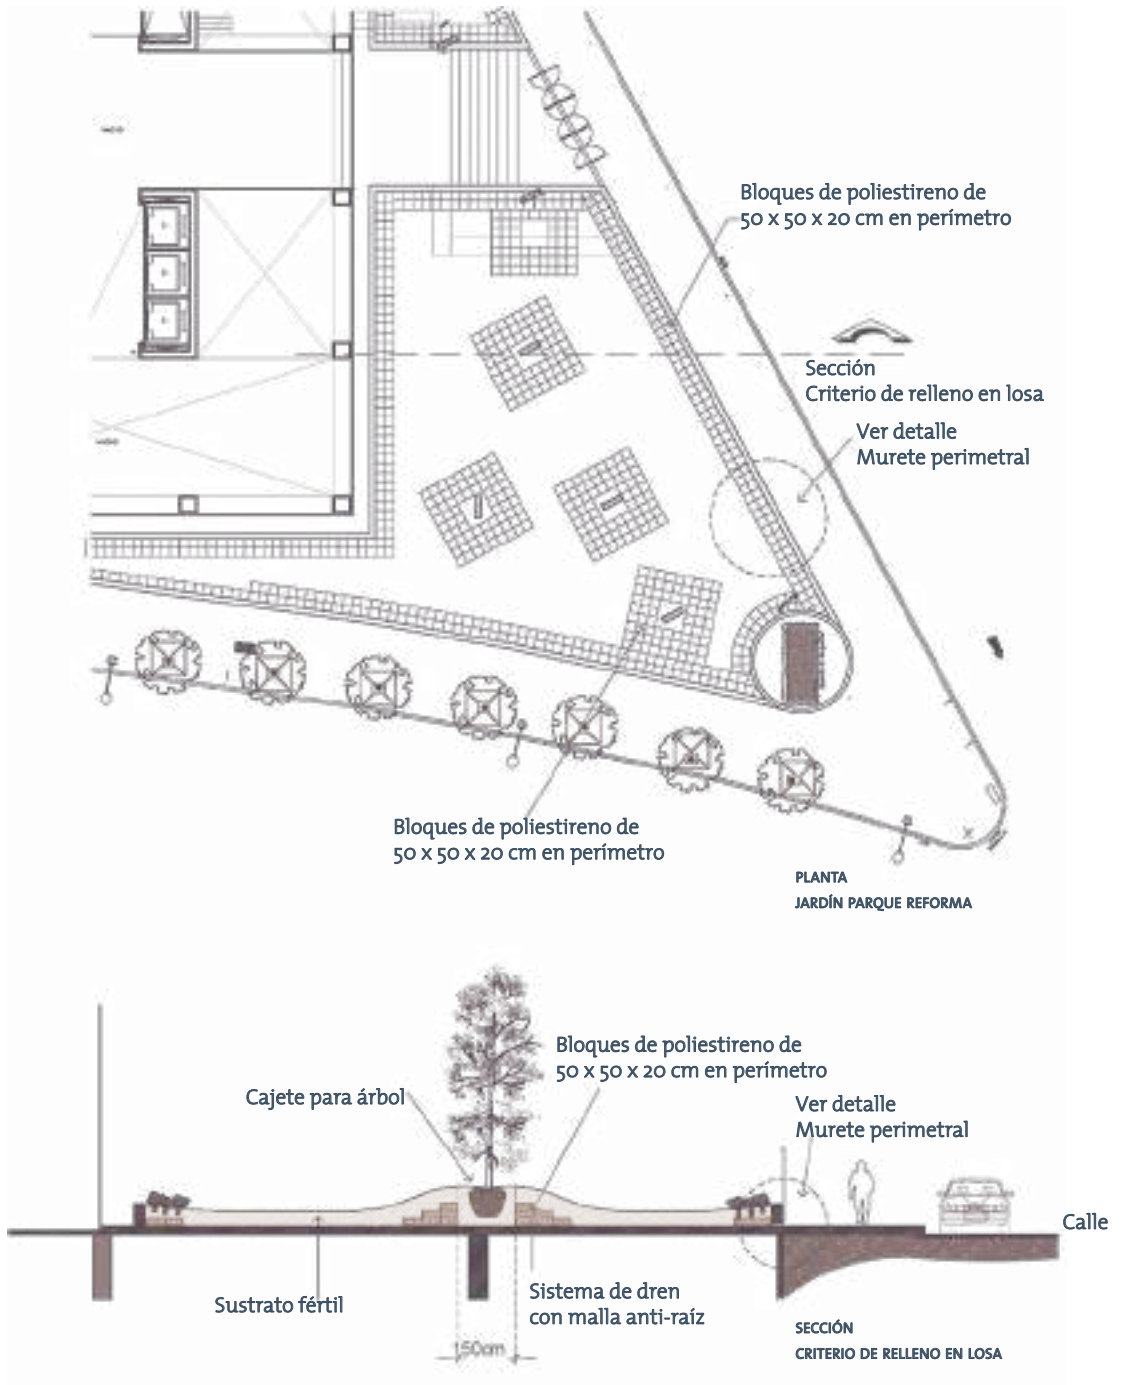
Detalles de jardín sobre estructura, Parque Refoma
